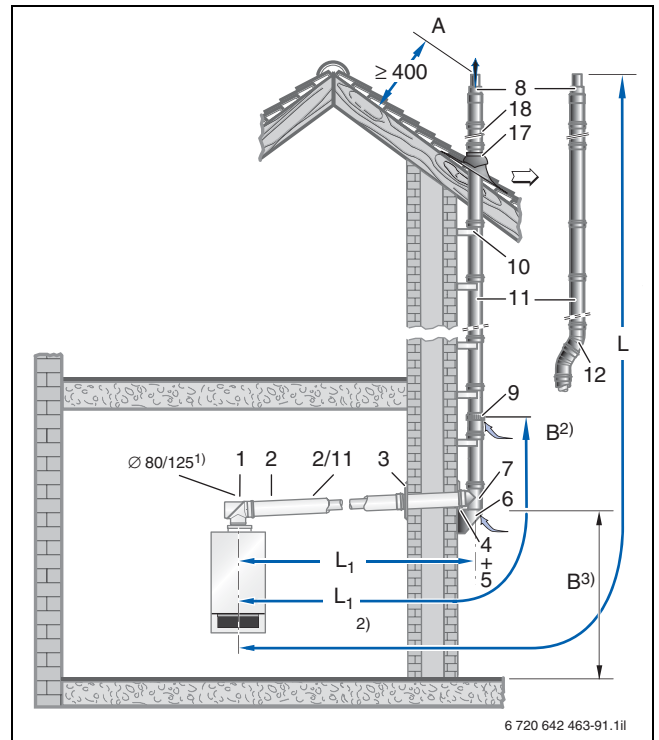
Montagevariante mit dem Bausatz GAF-K
